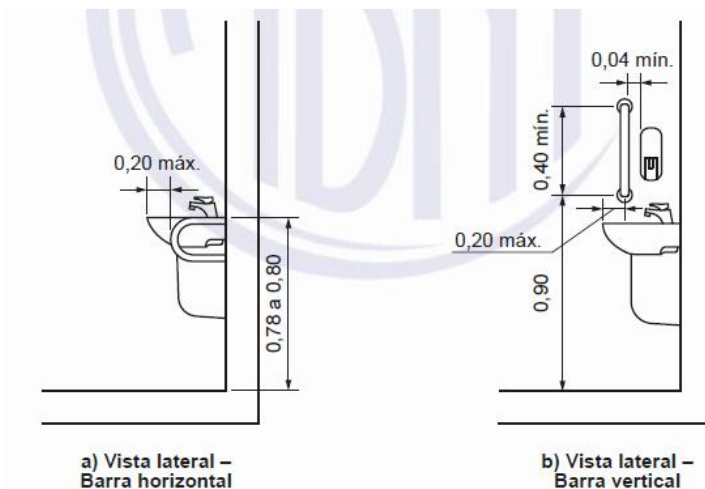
Modelos de opções de instalação de lavatórios e barras de apoio – Vista lateral (Obs: Medidas em metros) - Fonte: NBR9050/2020
